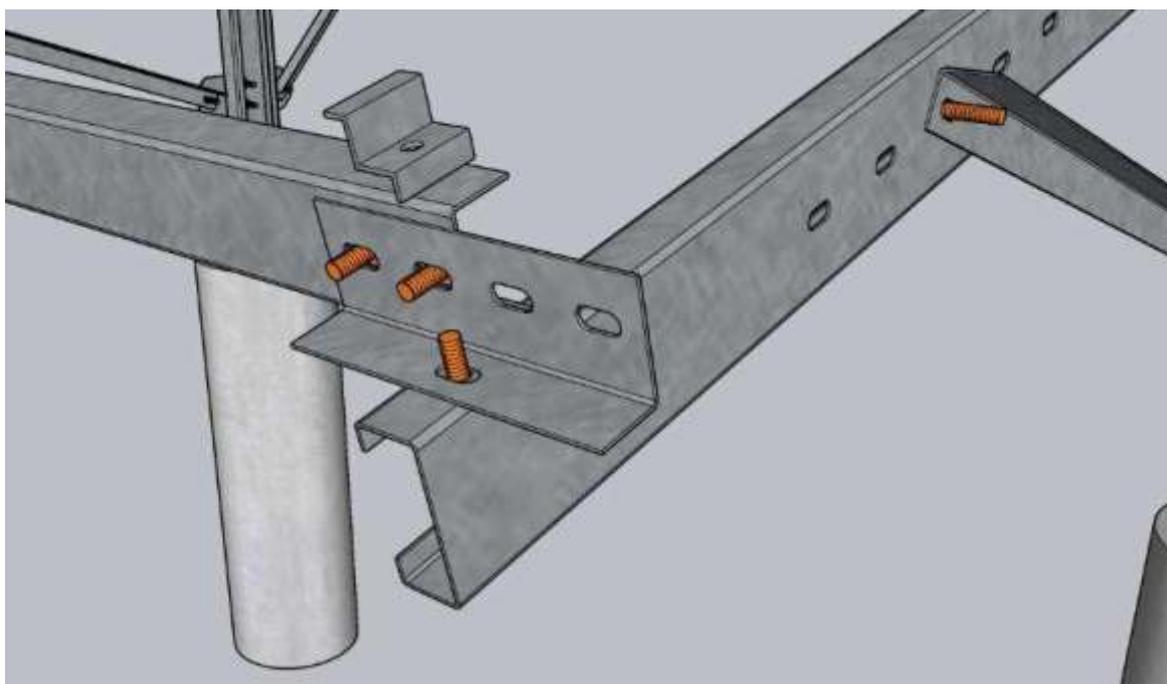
IMAGEM DA ESTRUTURA PARA 10 PLACAS
